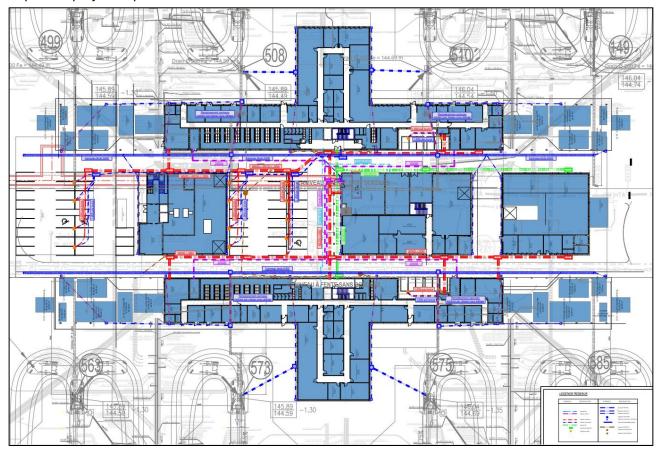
Plan du bâtiment central et des groupes de production du projet L14 sur le site Jean-Luc Lagardère
